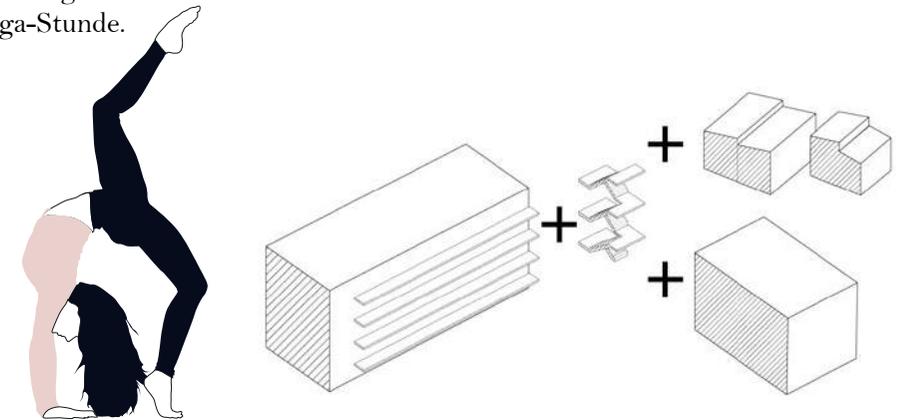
Typologie 5 - Anbau an Plattenbau
